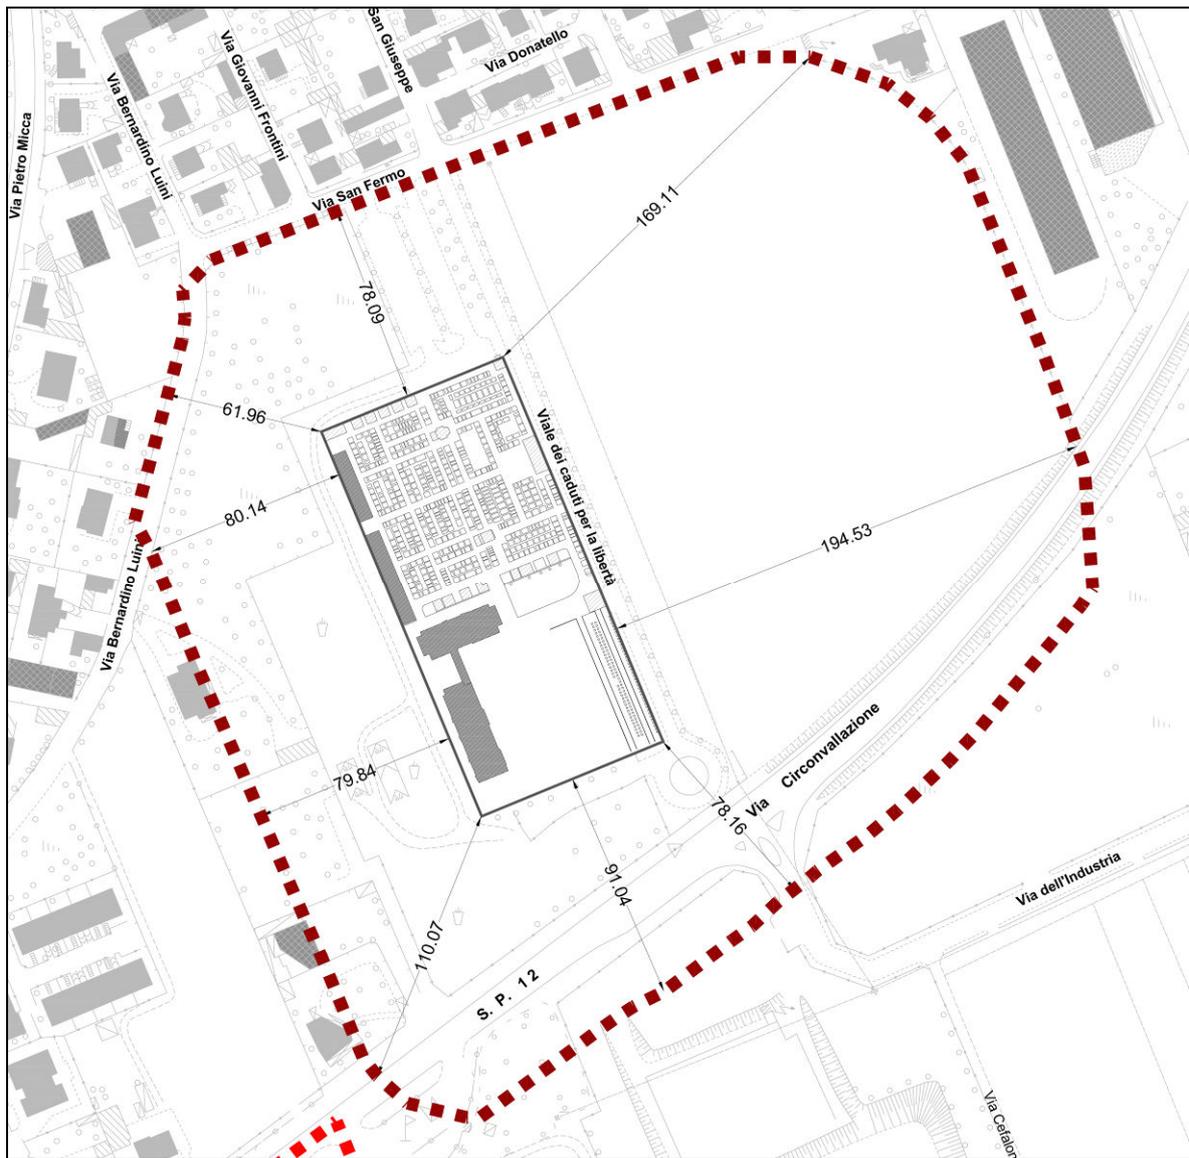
Estratto Elaborato 4 Fascia di rispetto di progetto
